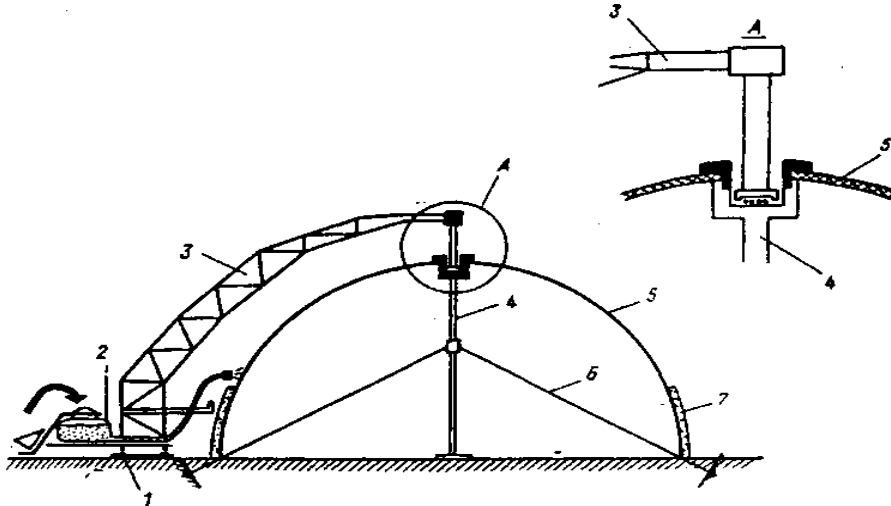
Схема бетонування купольного покриття по м'якій надувній опалубці:
